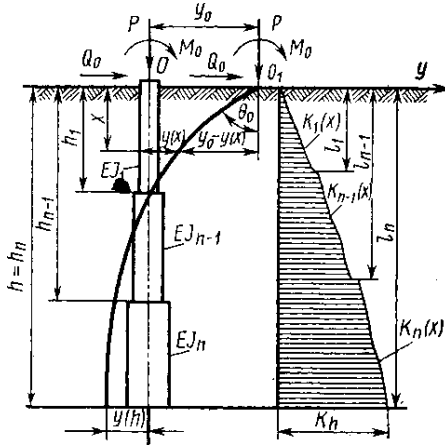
Расчетная схема гибких фундаментов глубокого заложения при продольно-поперечном изгибе
